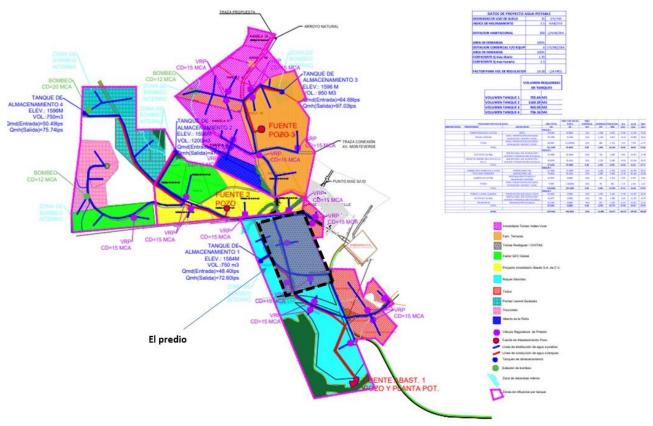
Esquema preliminar de Infraestructura dentro del Plan Maestro de los propietarios de la zona (a futuro).
